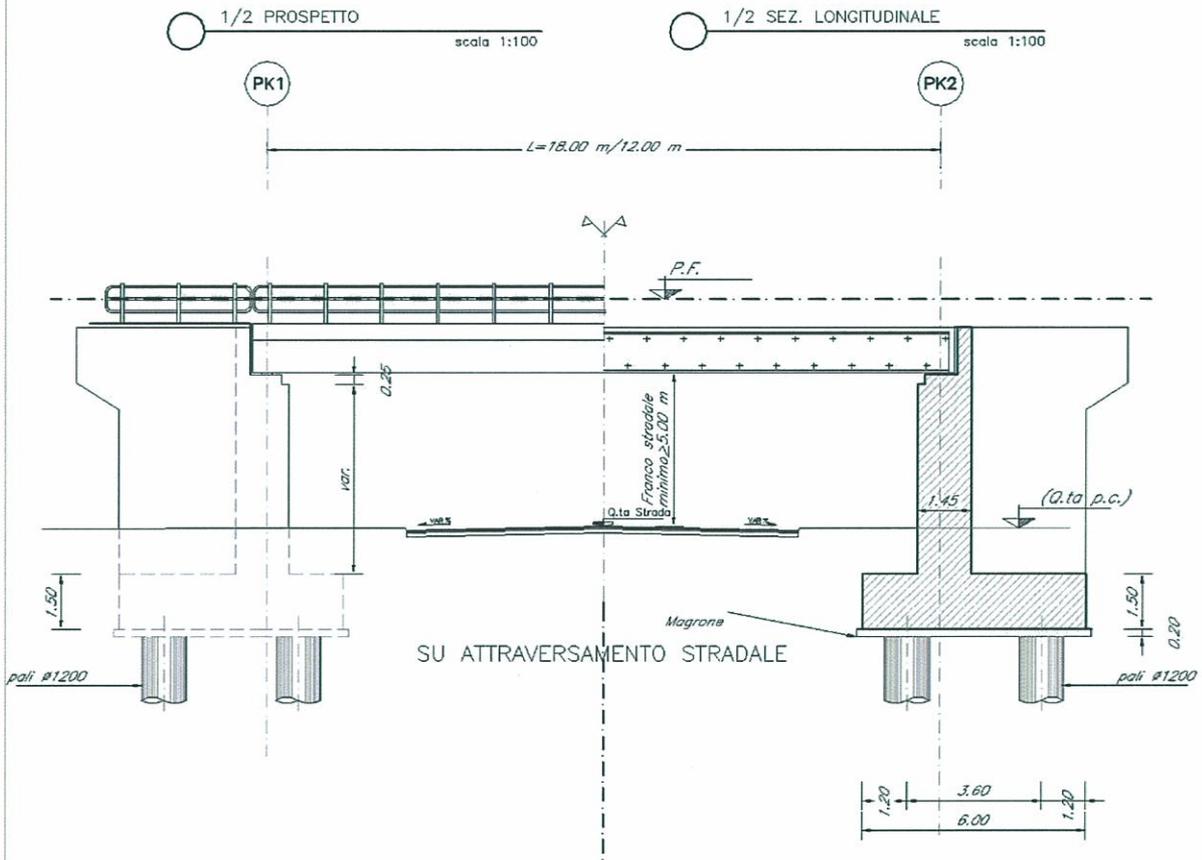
Prospetto/Sezione longitudinale in corrispondenza di attraversamento stradale.
